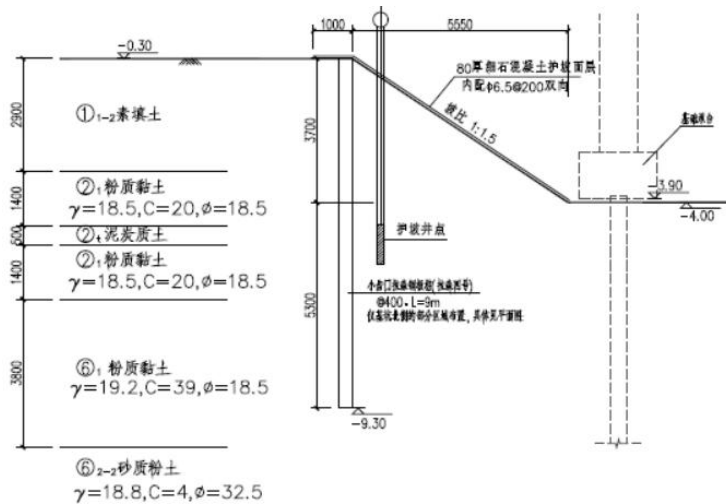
青浦地块基坑开挖竖向布置示意图
